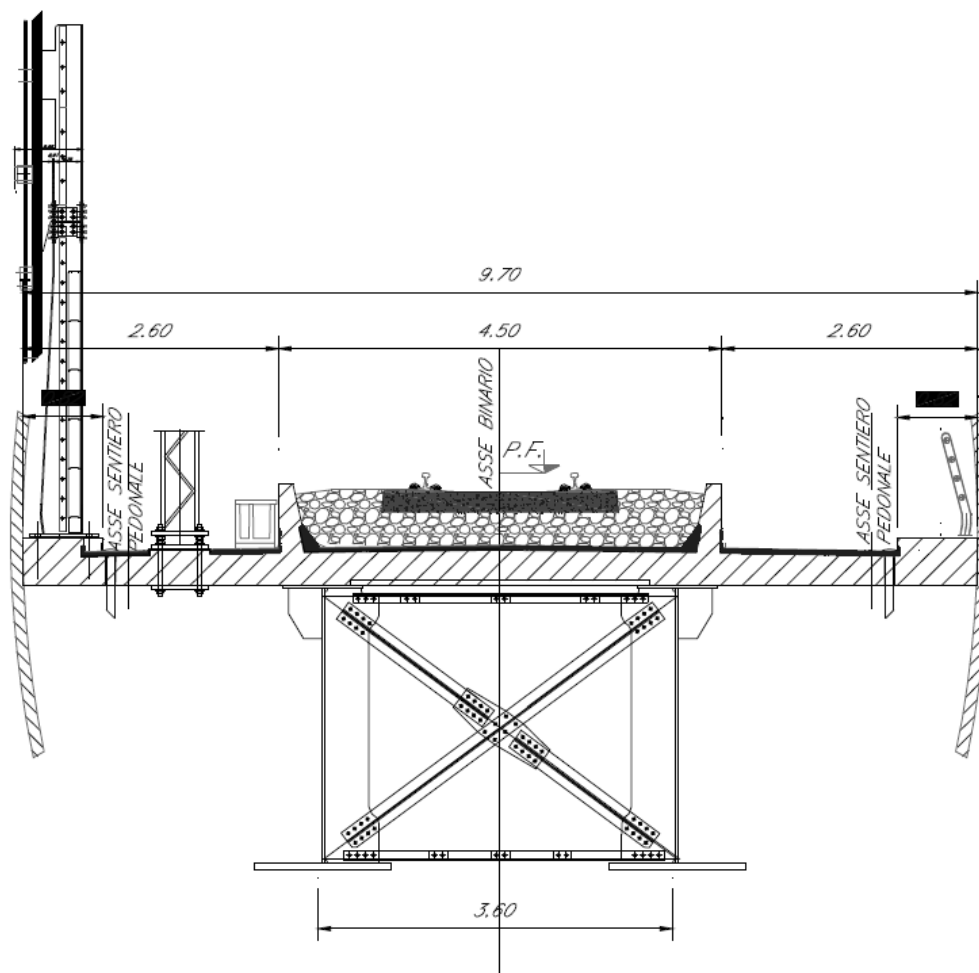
Sezione tipo dell'impalcato a struttura mista acciaio calcestruzzo a singolo binario
